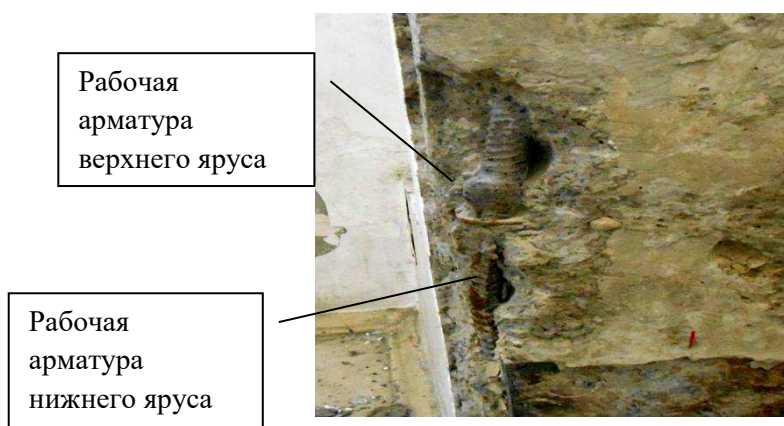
Вскрытый стык колонн в осях Д/10 на 3 этаже
